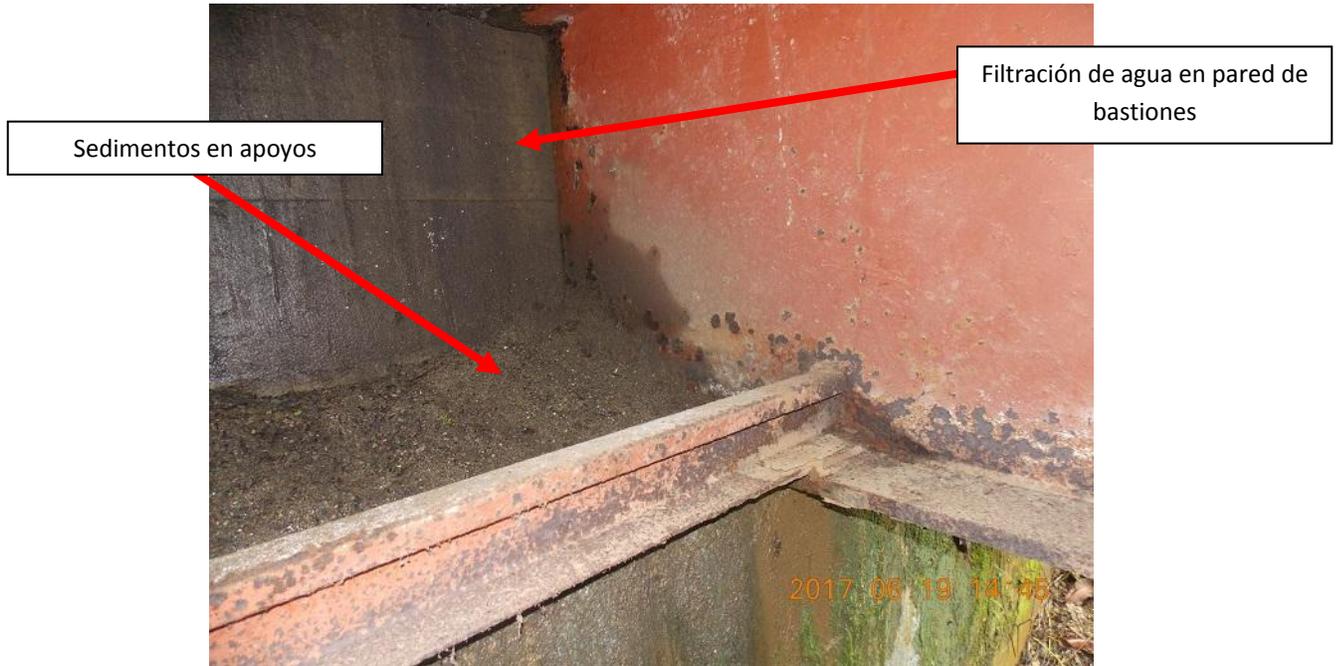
Puente sobre la quebrada Ernesto. Oxidación localizada y Apoyos cubiertos con sedimentos
